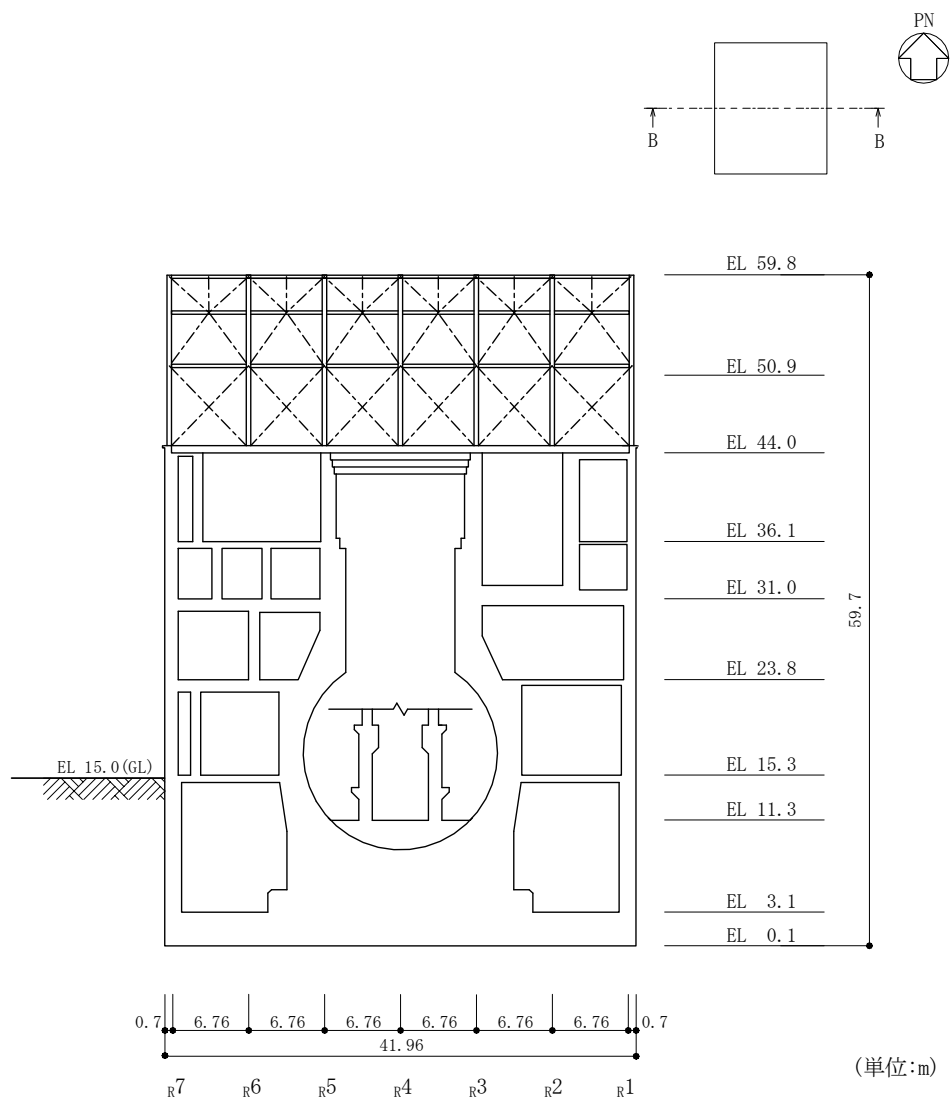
(2) 1号機原子炉建物の概略断面図 (B-B断面, EW方向)
